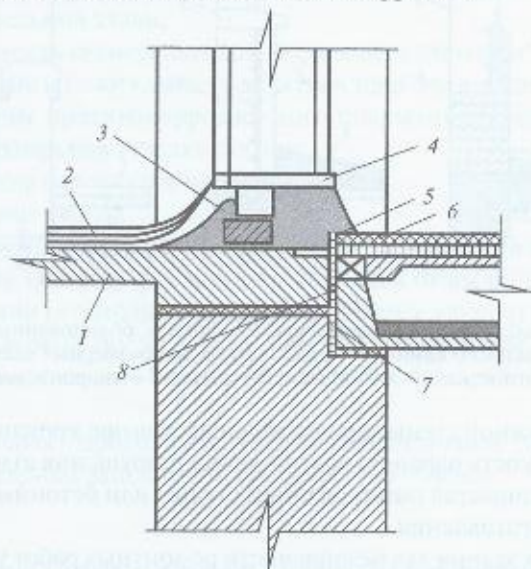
Сопряжение балконной плиты с наружной стеной:
